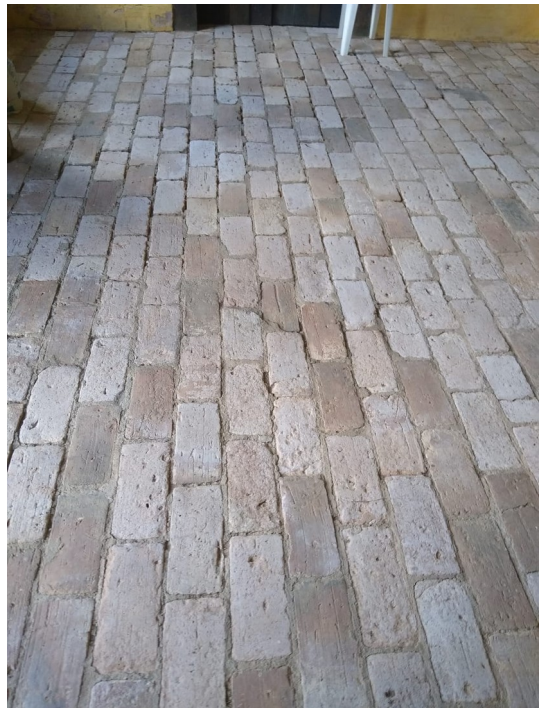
Detalhe de sala interna com piso tijolado higienizado, lixado e rejuntado.
